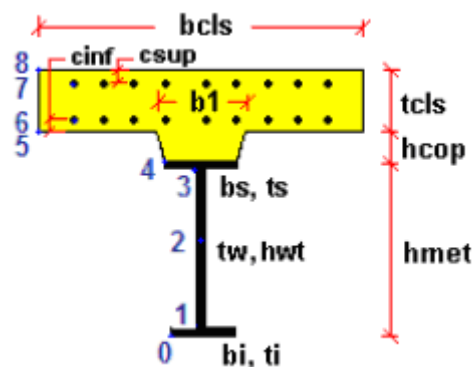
Dati caratterizzanti la sezione mista acciaio-calcestruzzo
